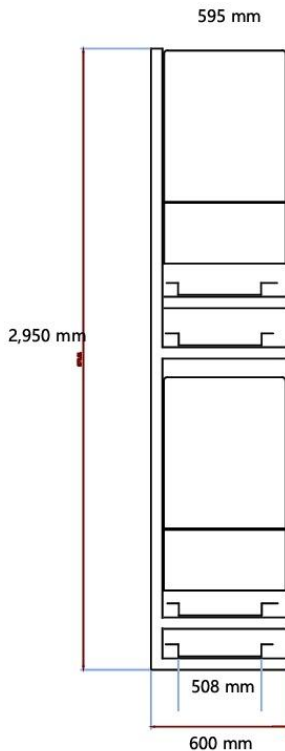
Vista de perfil de la distribución de los inversores en sala eléctrica, los acotamientos en la distribución cumplen con las especificaciones del fabricante.
